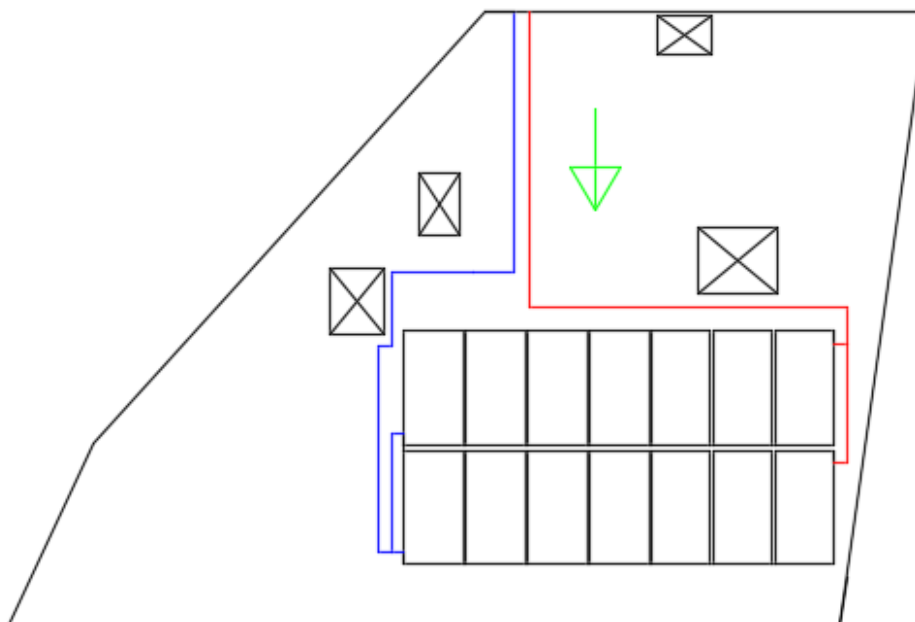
Layout del campo solar de captadores planos [AutoCAD]
